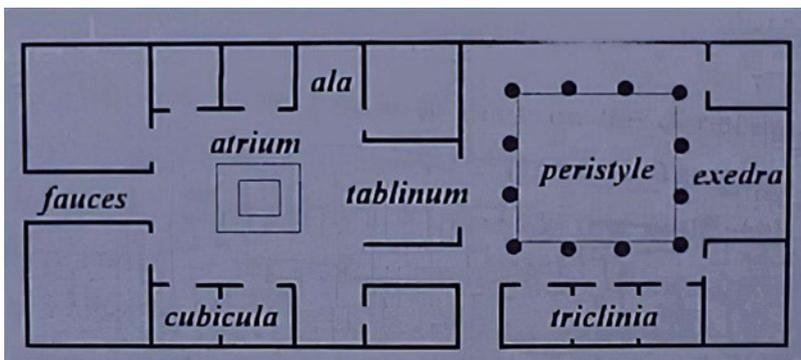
Planta romana, origen de la planta de la casa señorial colonial
